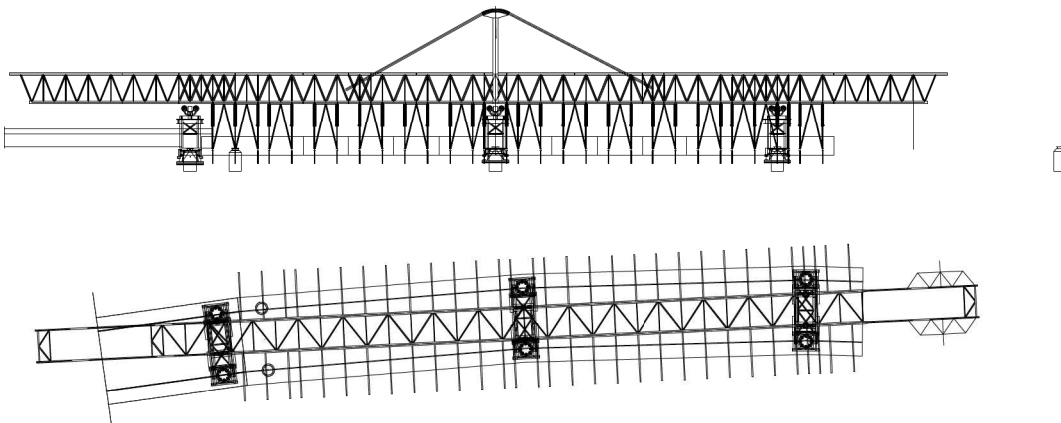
Alzado (arriba) y planta (abajo) de autocimbra para construcción simultánea de 2 vanos de 25 m de luz
